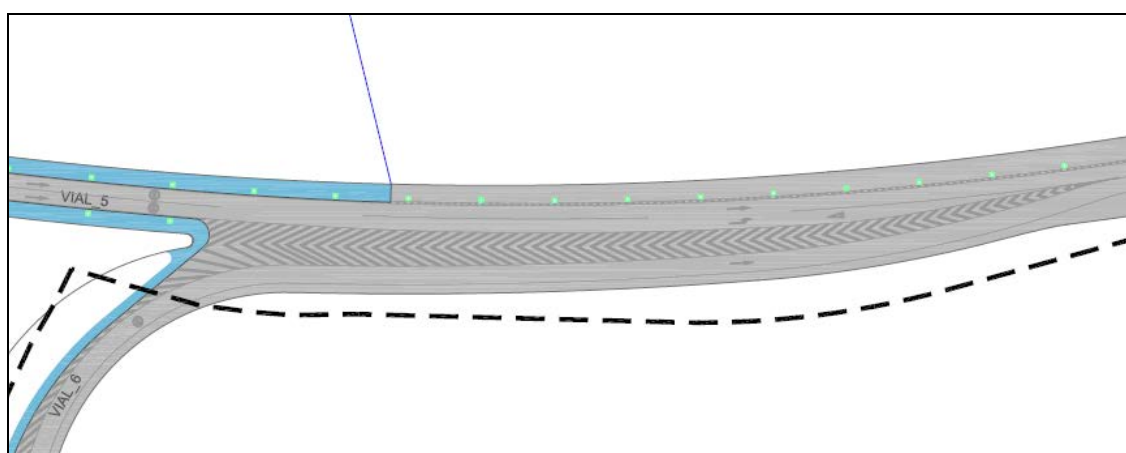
Intersección entre el enlace de la autovía y la vía perimetral
